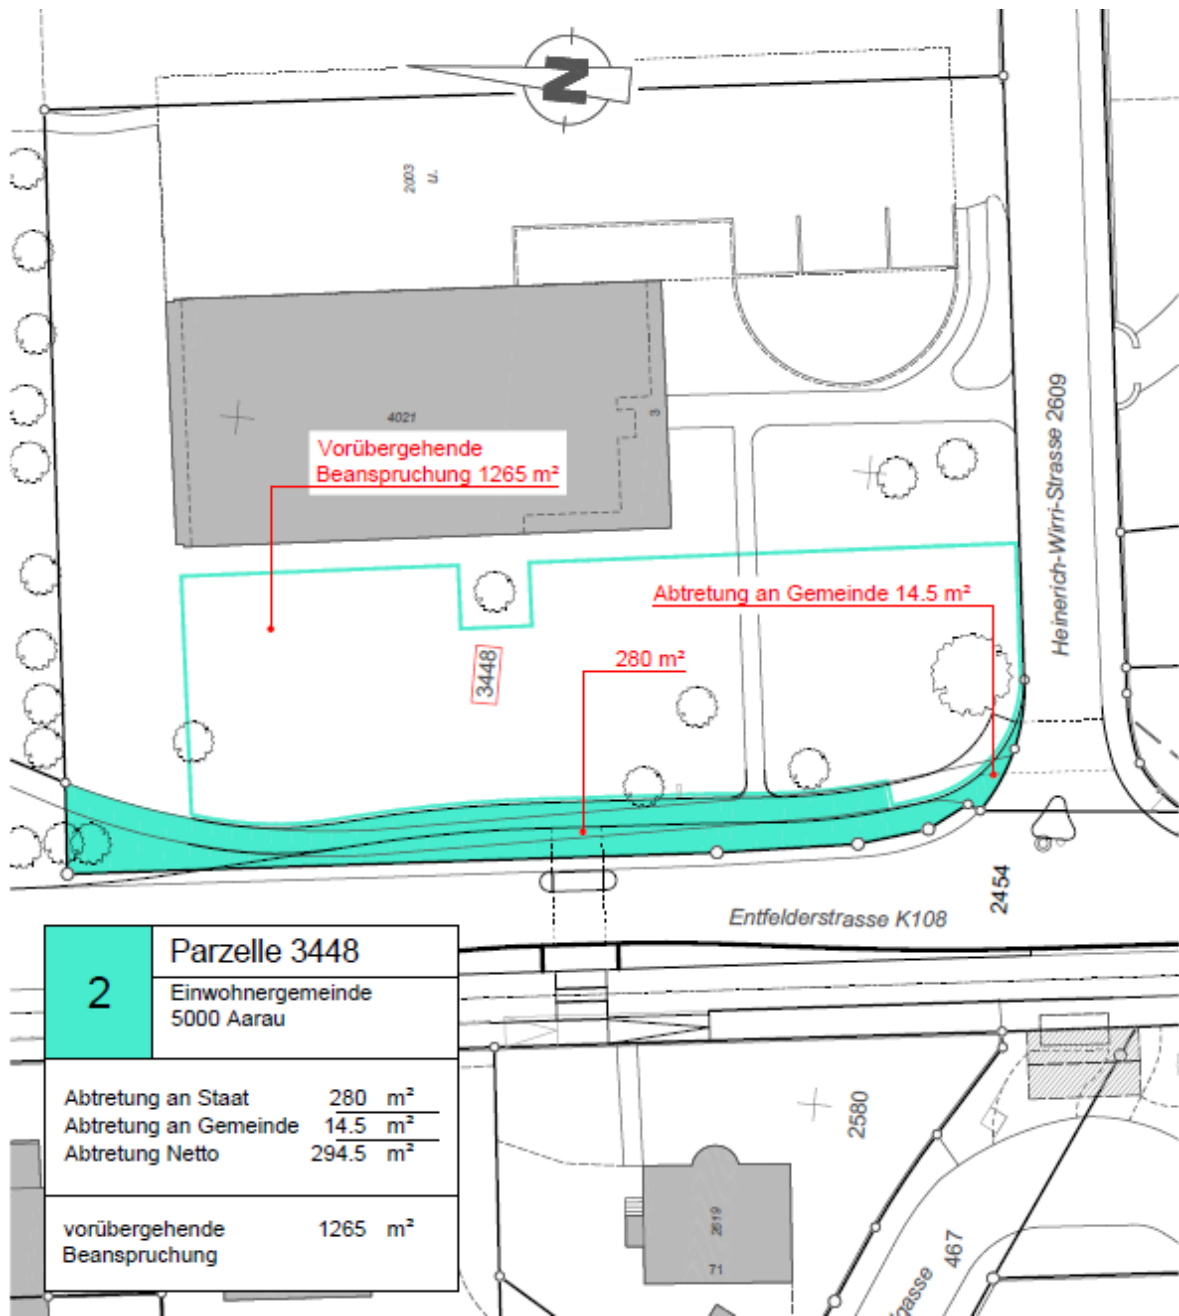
; Planausschnitt, Parzelle Nr. 3448 (HWS3) gem. Aktenauflage 1
